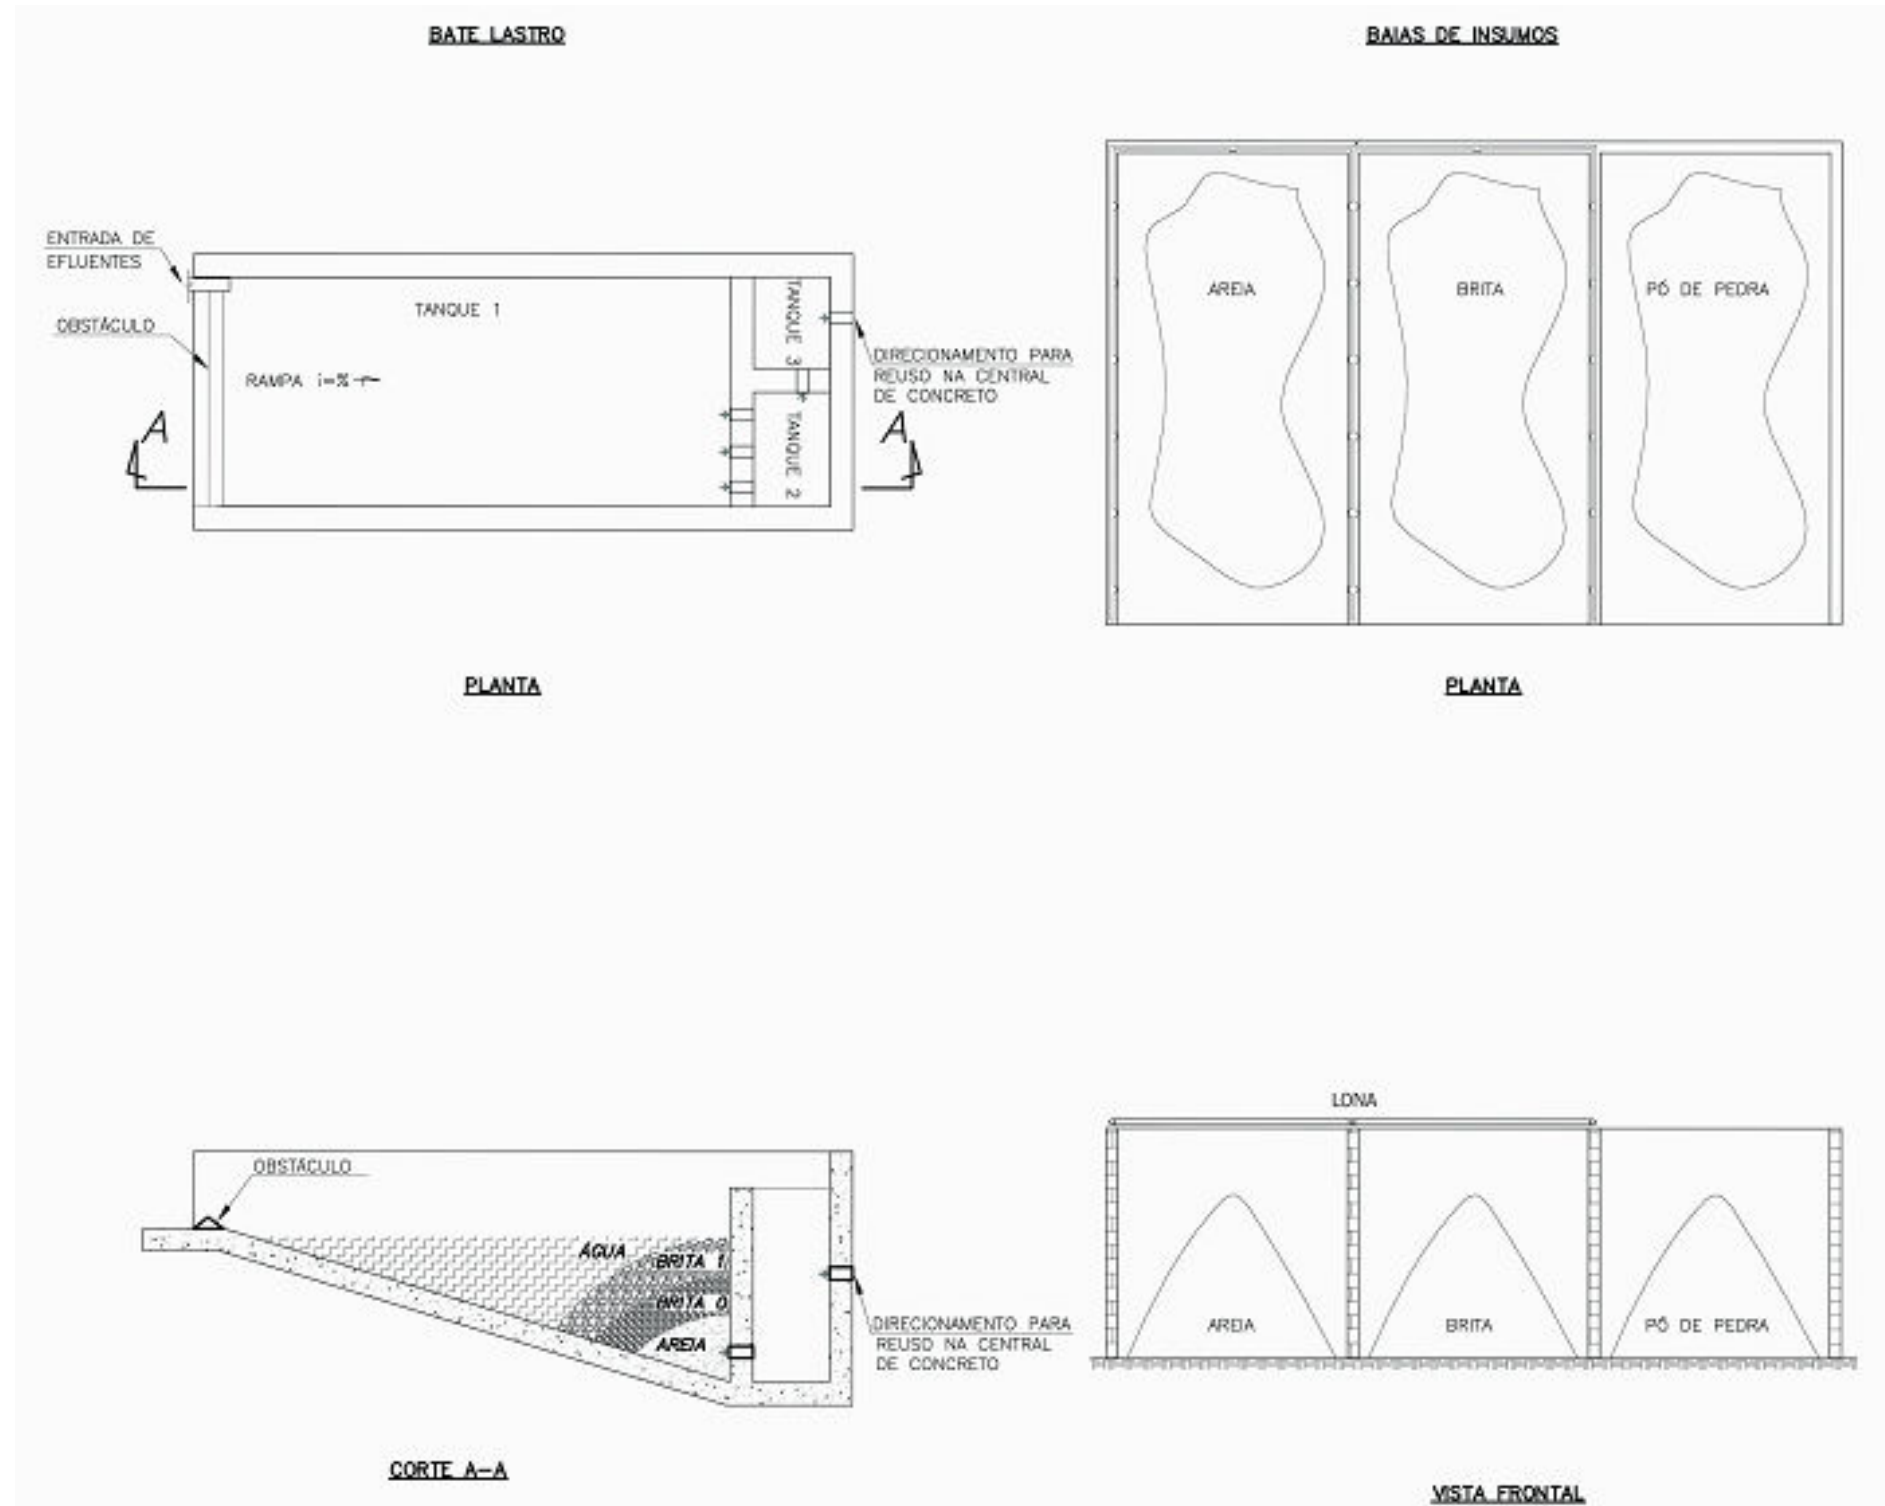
Instalação temporária da Central de Concreto
